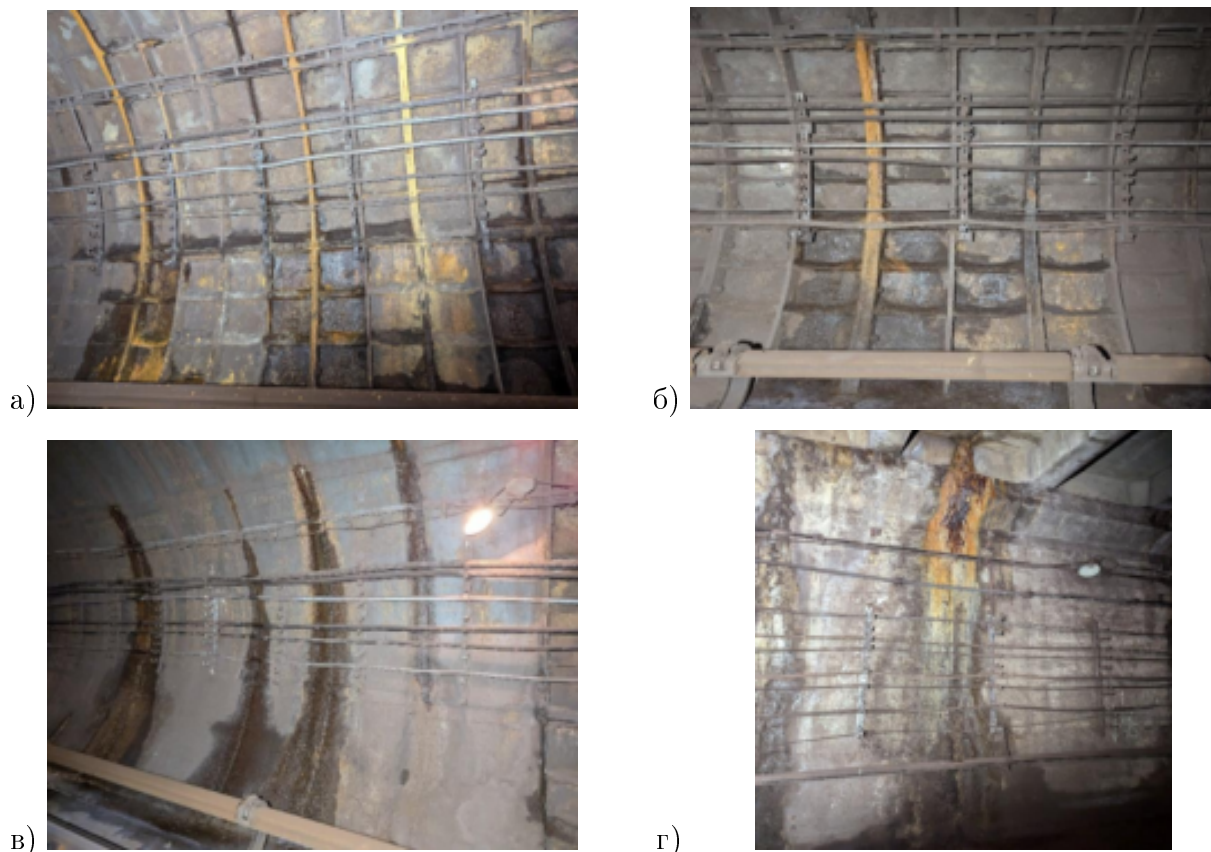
Характерные дефекты обделки тоннеля на исследуемом перегоне (коррозионные повреждения, течи, намокание конструкции): а, б – участки с чугунной обделкой; в – участок с металлоизоляцией; г – участок со сборной железобетонной обделкой
